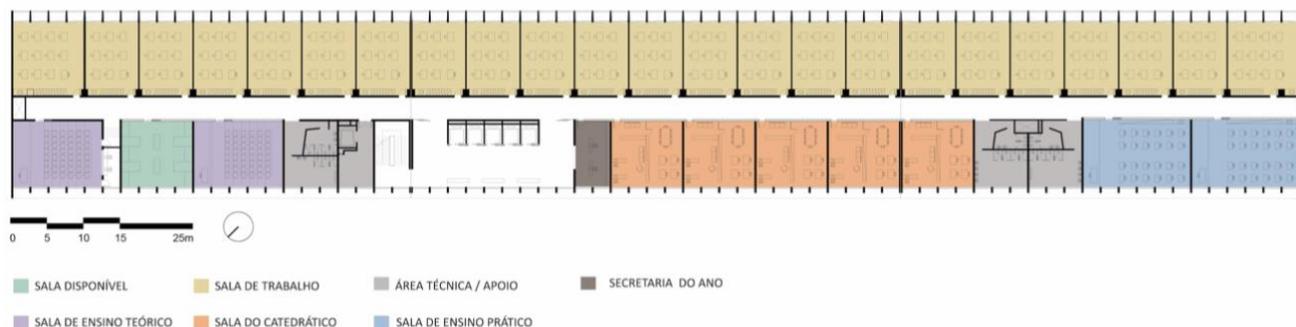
Planta Baixa setorizada do projeto original do pavimento tipo do bloco A do Edifício JMM.
